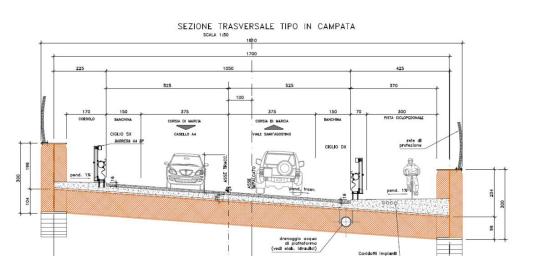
Ponte sul F. Retrone – Sezione tipo.
